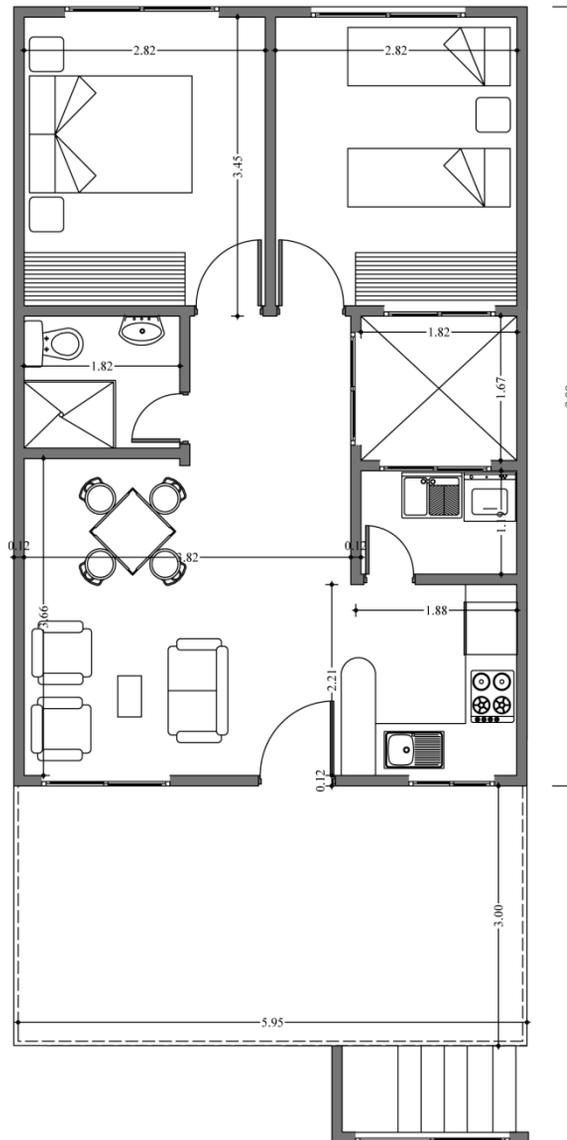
Planta arquitectónica tercer piso vivienda trifamiliar
